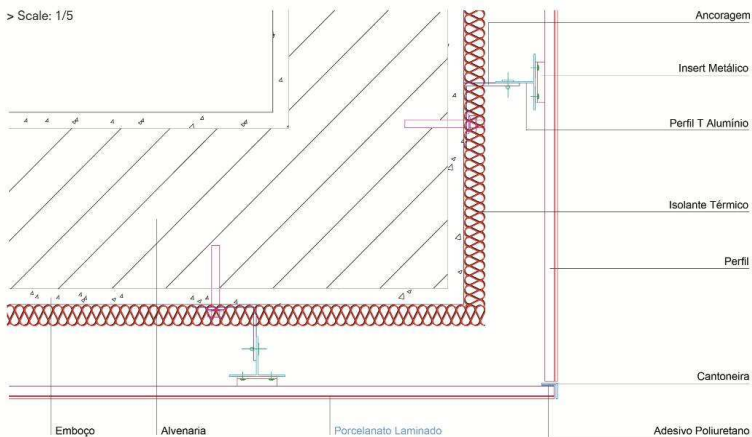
Ancoragem das placas com sistema de fixação oculto. Detalhe do sistema: canto externo.
